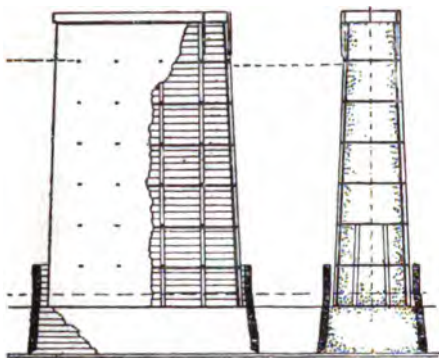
Pile en béton d'un pont sur le Red-River (d'après d'Engineering Oews.
